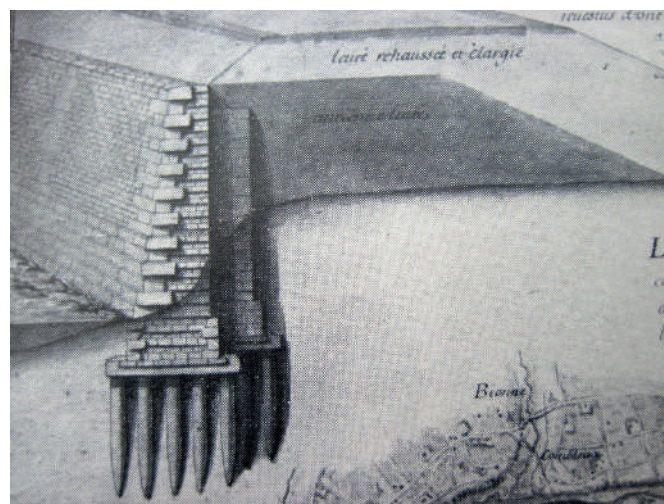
Montlivault (41), mur de soutènement d'une ancienne levée mis en œuvre par Colbert (extrait d'un plan dressé par l'ingénieur Mathieu peu après la crue désastreuse de juin 1709; détail, planche 28, Dion R., 1961, p. 268).
